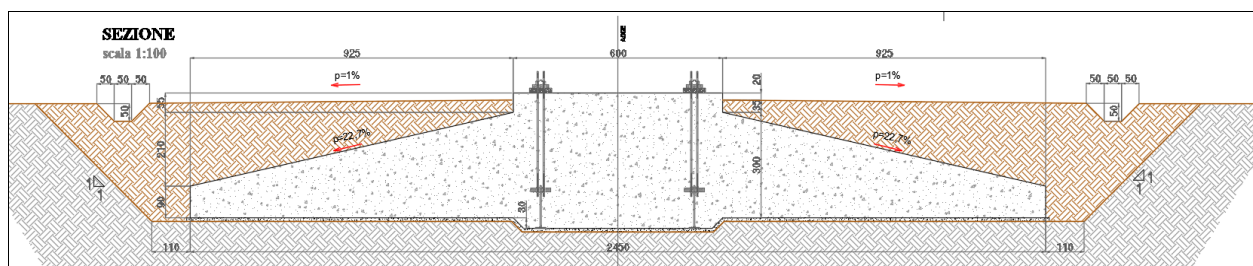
Geometria della fondazione diretta dell'aerogeneratore
